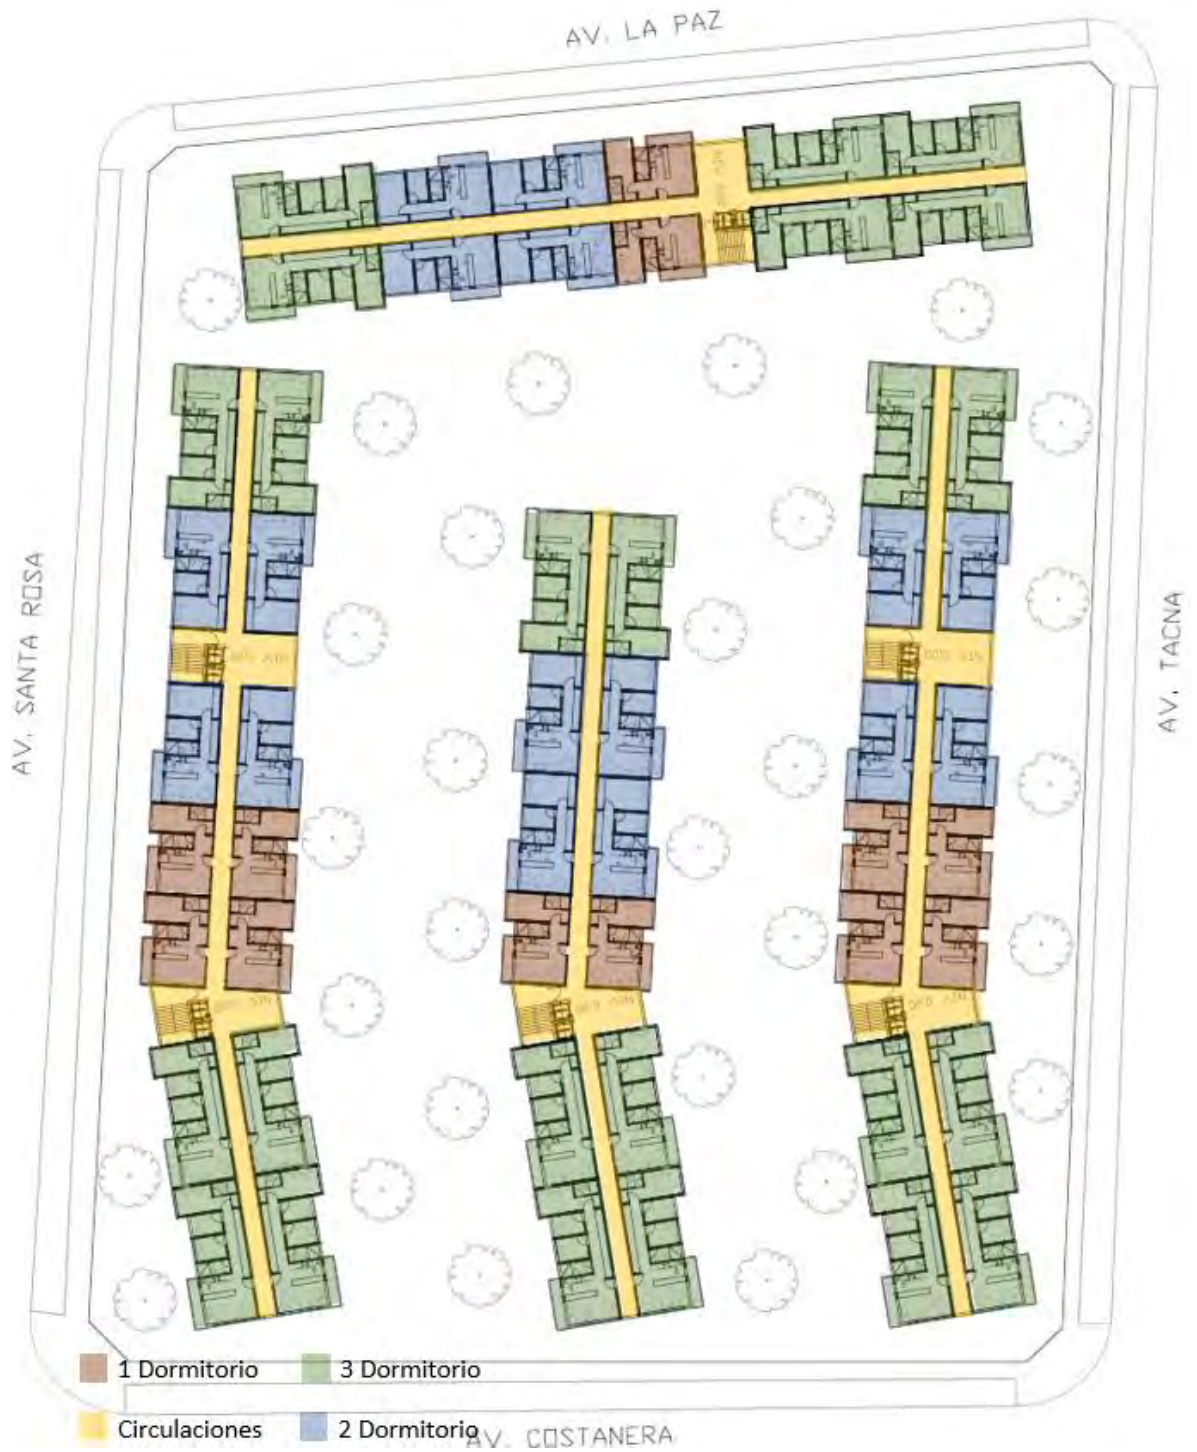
Esquema de tipología de viviendas en planta típica. Elaboración propia
